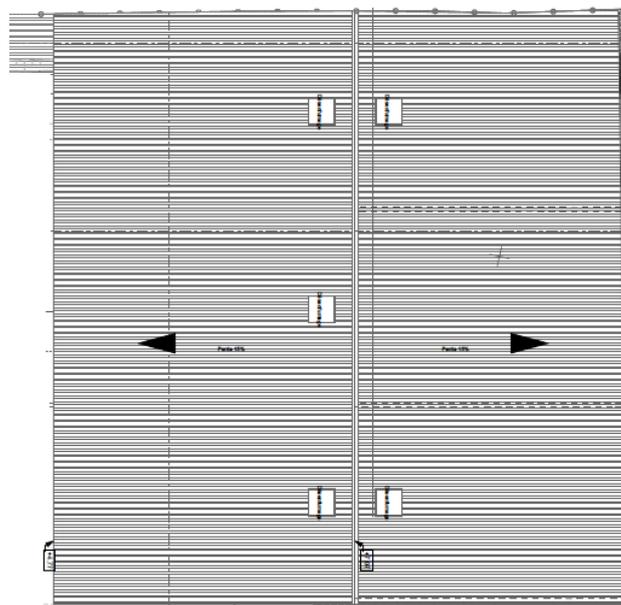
Plan de la toiture du bâtiment usinage panneaux
